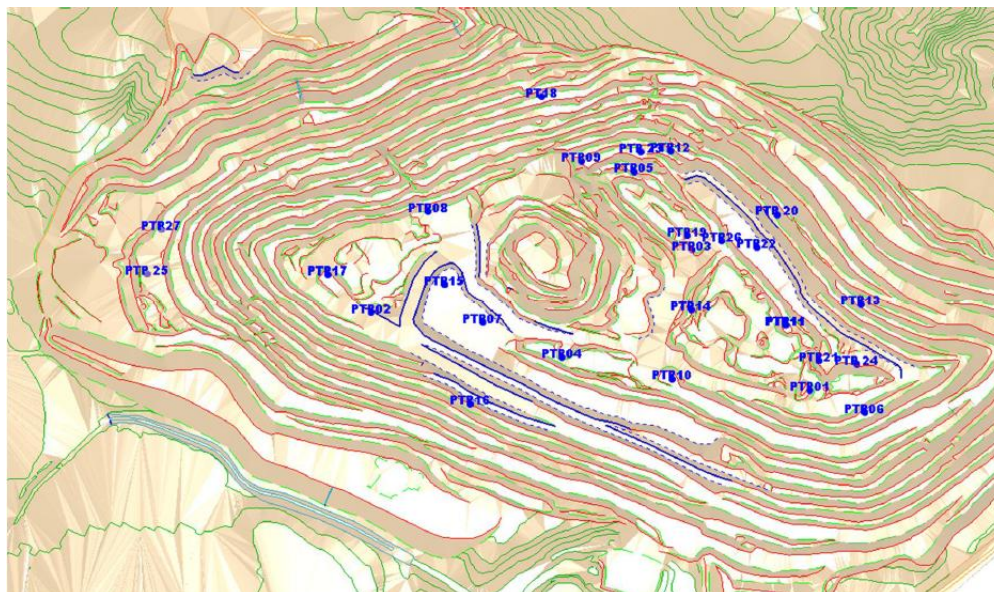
Exemplo de geometria do plano de Lavra da Mina de Capão Xavier.
